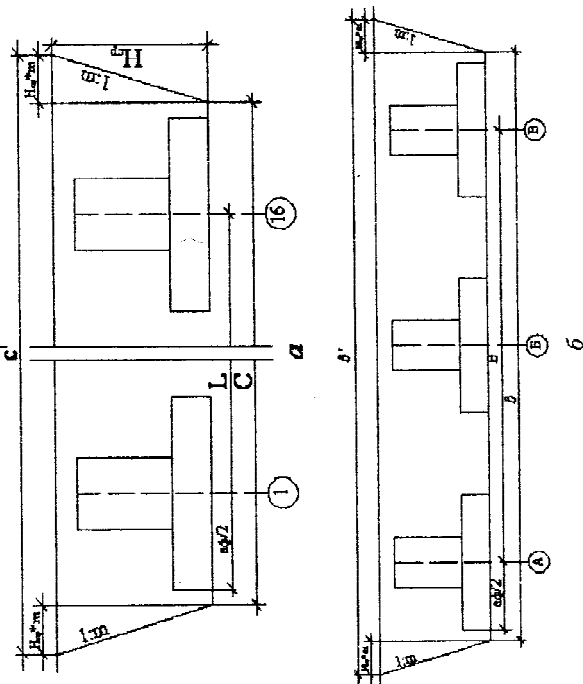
Схемы сечения котлована: а – продольного; б – поперечного
